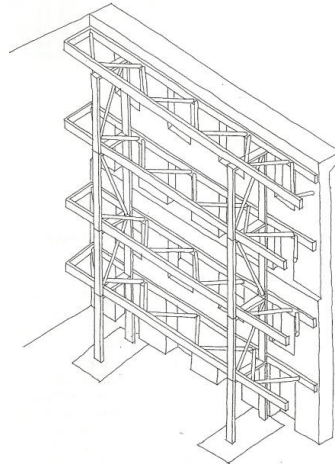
Esquema de estructura interna de estabilización (Espassandín & García, 2009)
